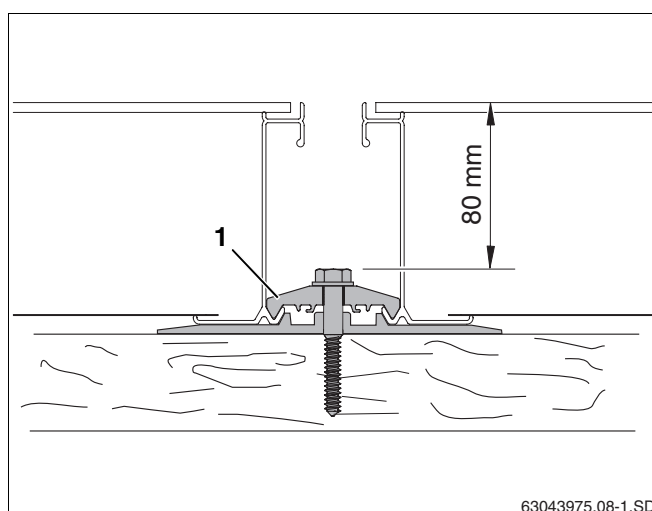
Avvitamento del giunto di collegamento bilaterale
